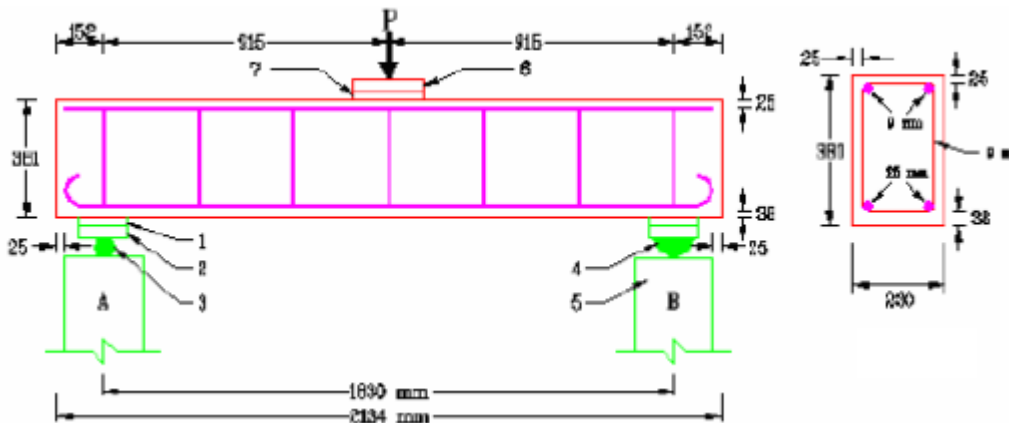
Dimensions de la poutre et dispositions des renforcements
